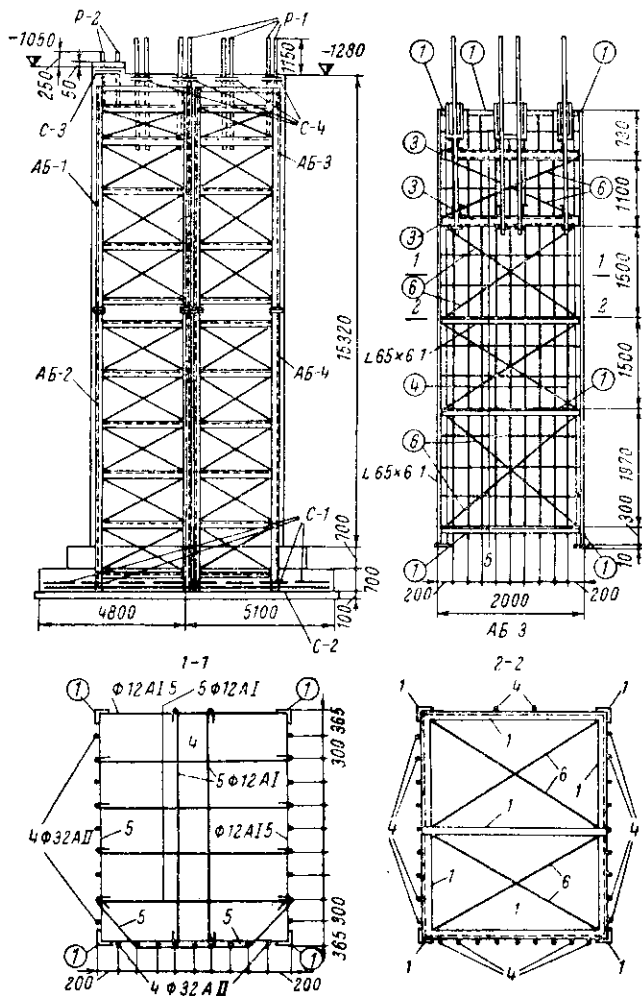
Пример армирования крупного фундамента арматурными блоками
